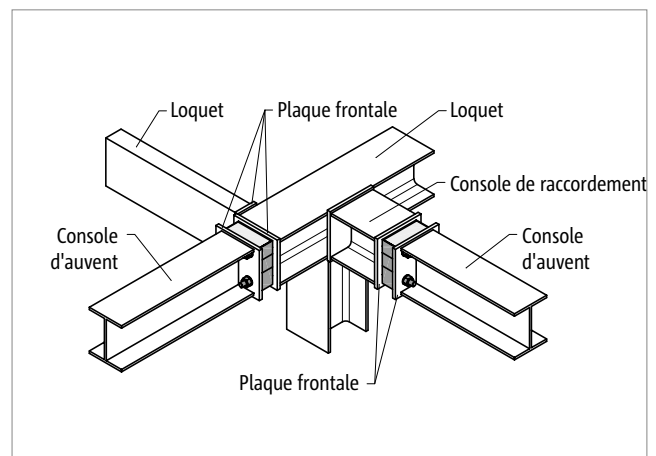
Schöck Isokorb® T type S : coin extérieur
